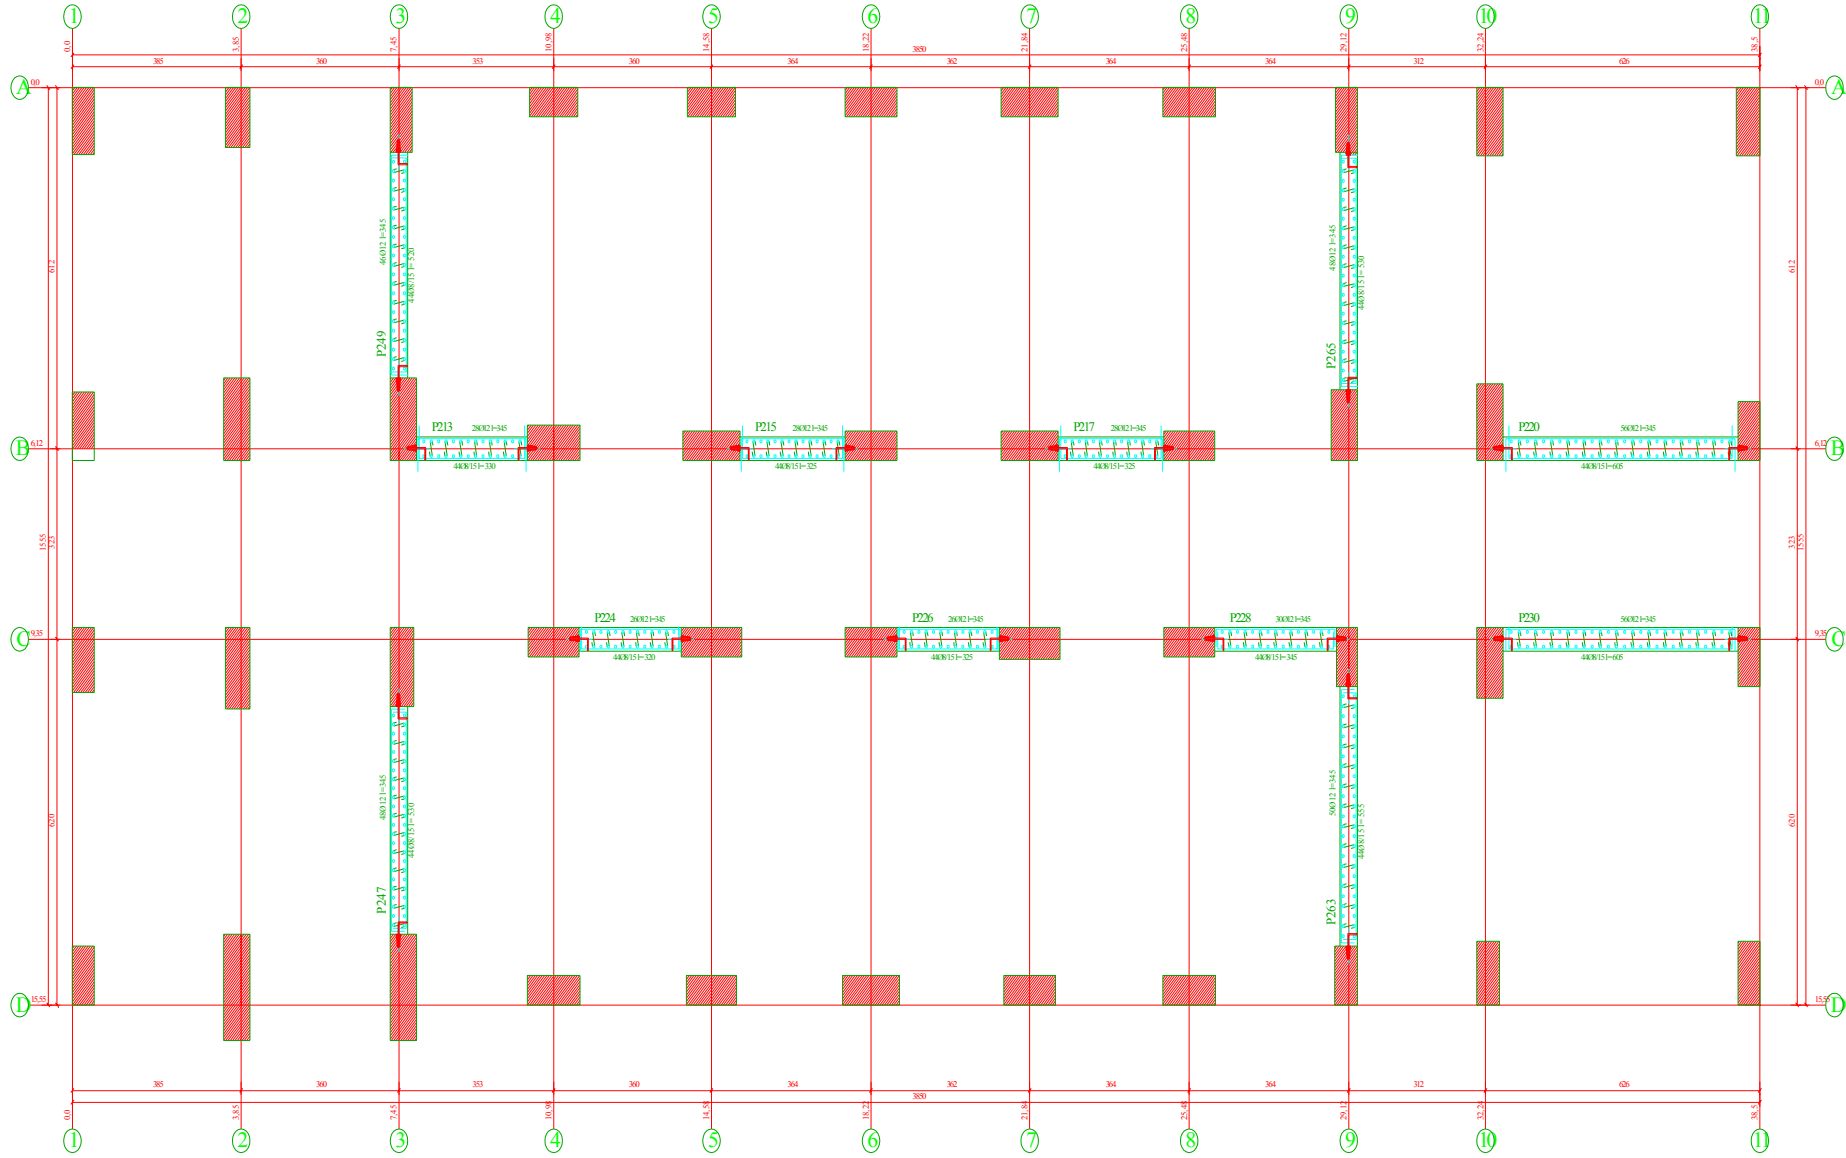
Şukriye Onsun Okul Binasına ait bodrum kat takviye kolon aplikasyon planı
